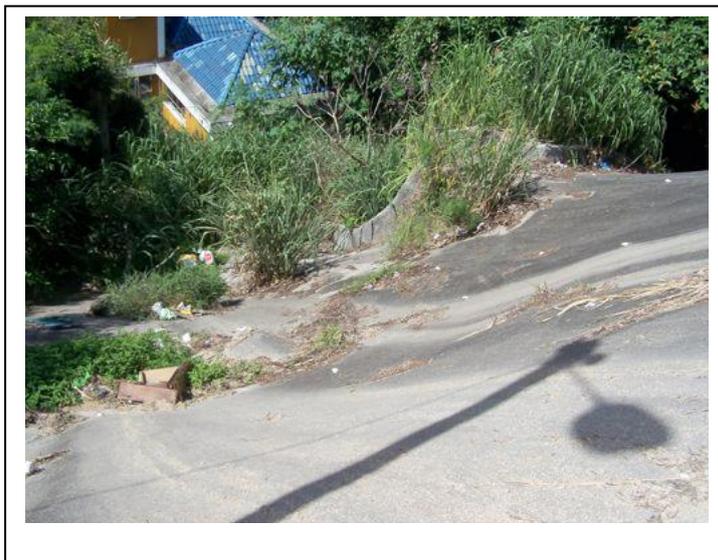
Primeiro plano, prédio da creche com telhado azul, ao fundo Casarão de Artes dos Prazeres. Acima desses equipamentos urbanos está a pedra deslocada.
